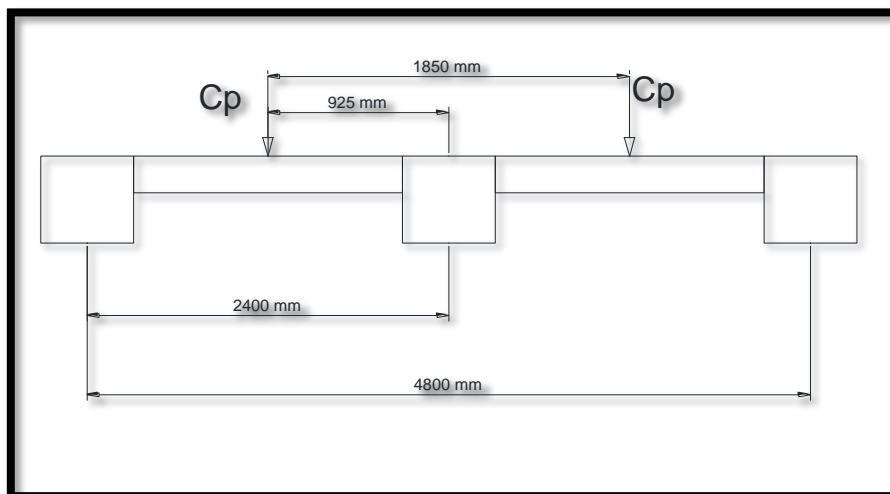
Disposición de carga puntual sobre la viga transversal
